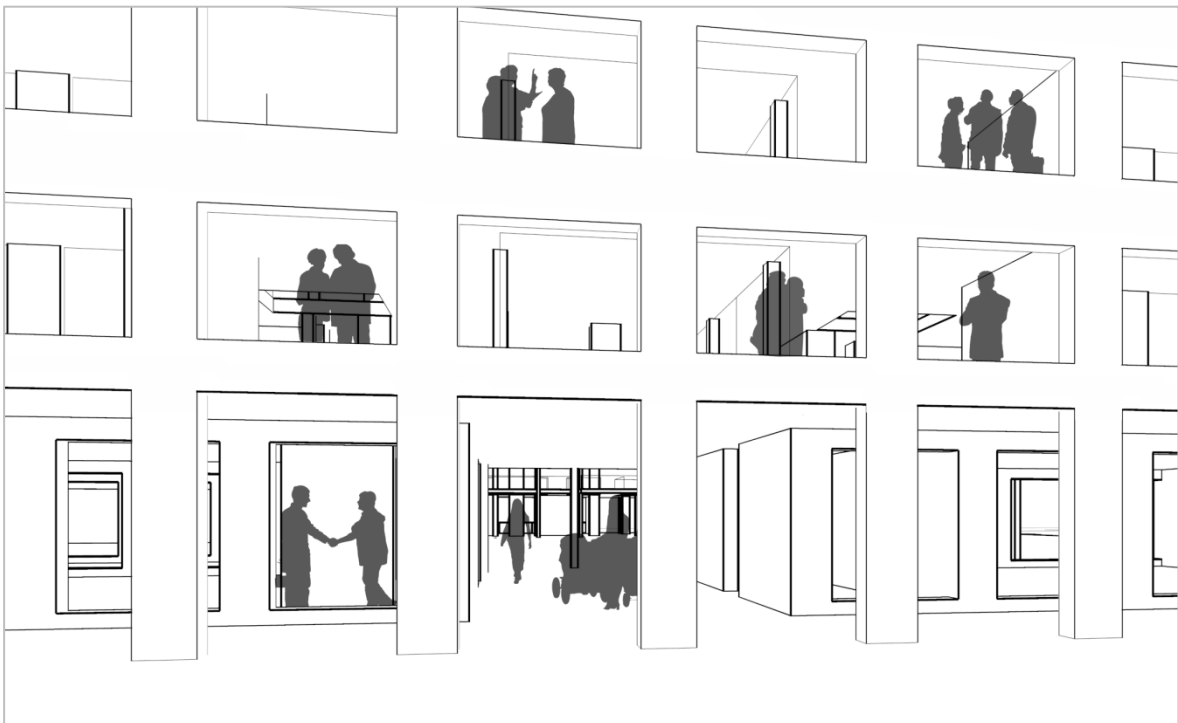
Eine breite Durchführung durch die Fassade in den Innenhof soll auch der Öffentlichkeit die Möglichkeit der Durchwegung vermitteln. Die Fassade zeigt Repräsentation nach Außen.
